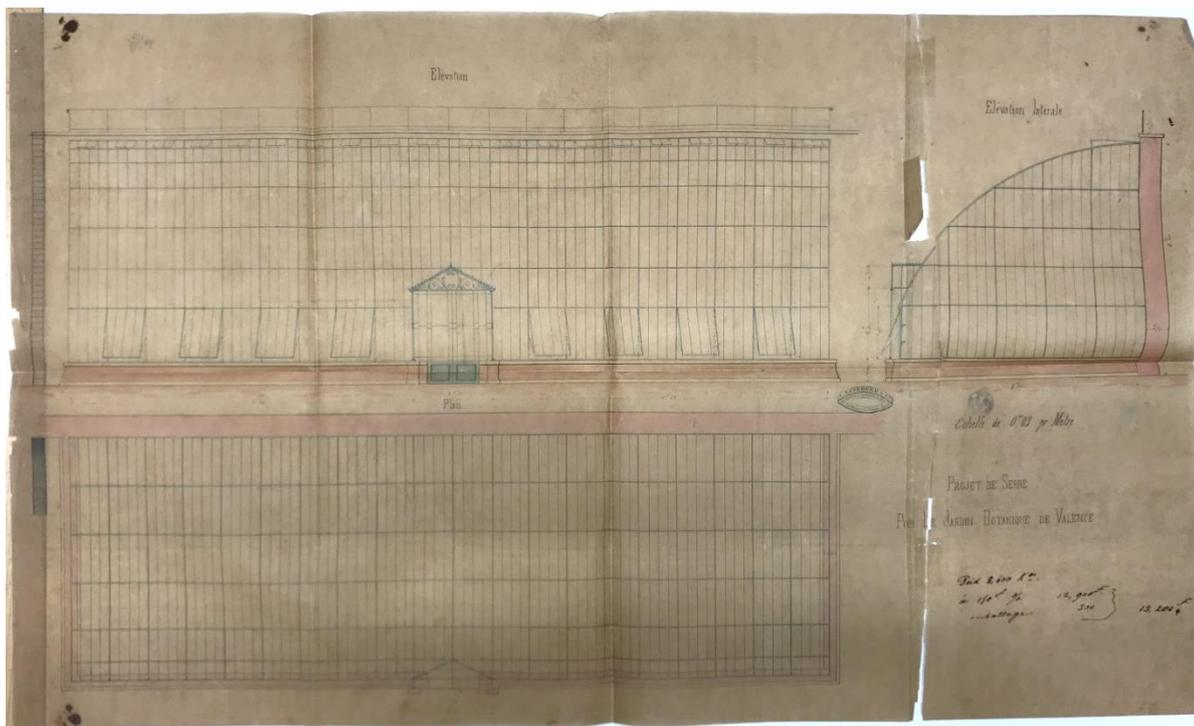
Proyecto para el invernadero tropical del Jardín Botánico de Valencia, alzados y planta de cubierta.1860. C. Lefebvre. 1860
